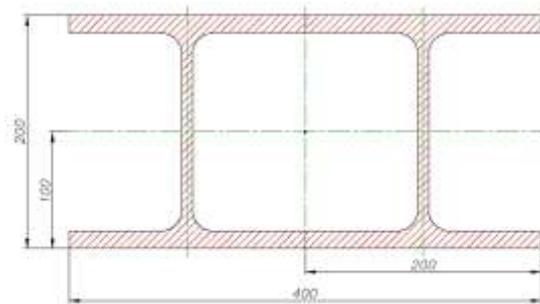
Sección transversal de la columna. Fuente: (Autor)
